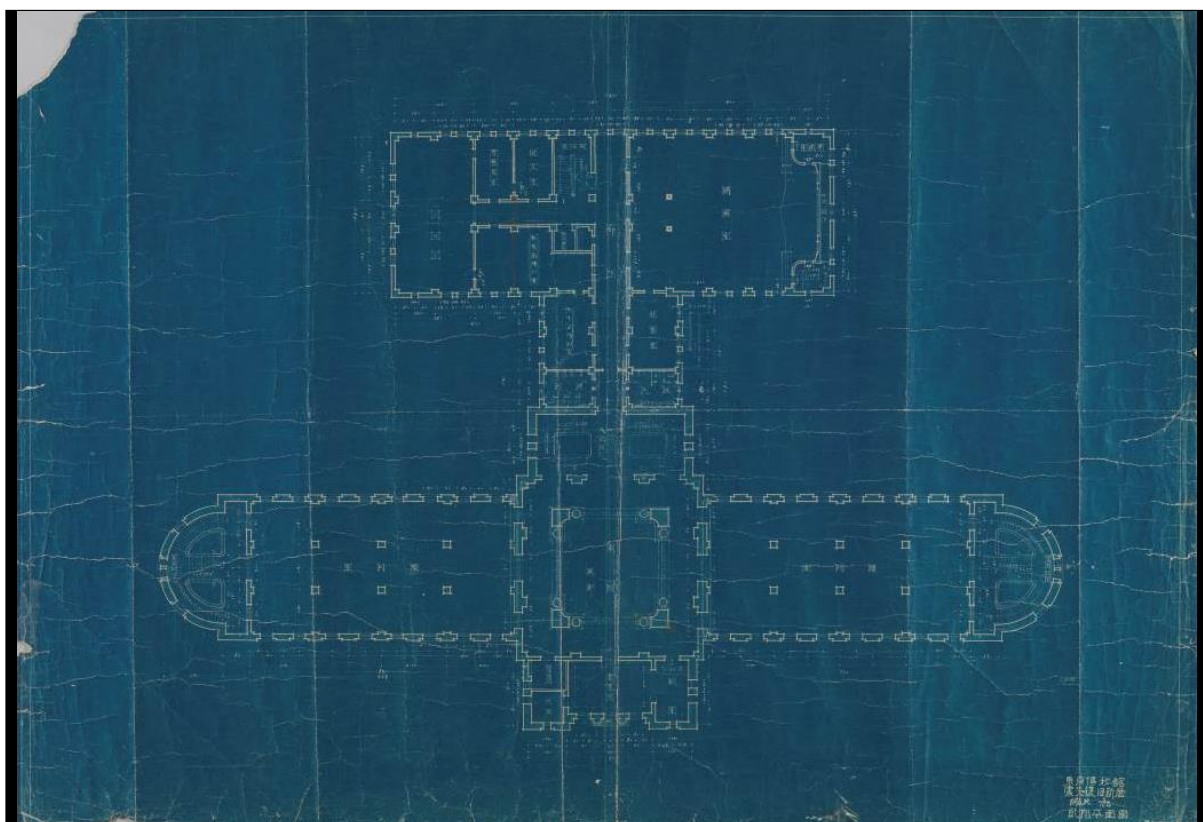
東京科学博物館震災復旧新営工事設計図（2 階平面図）
